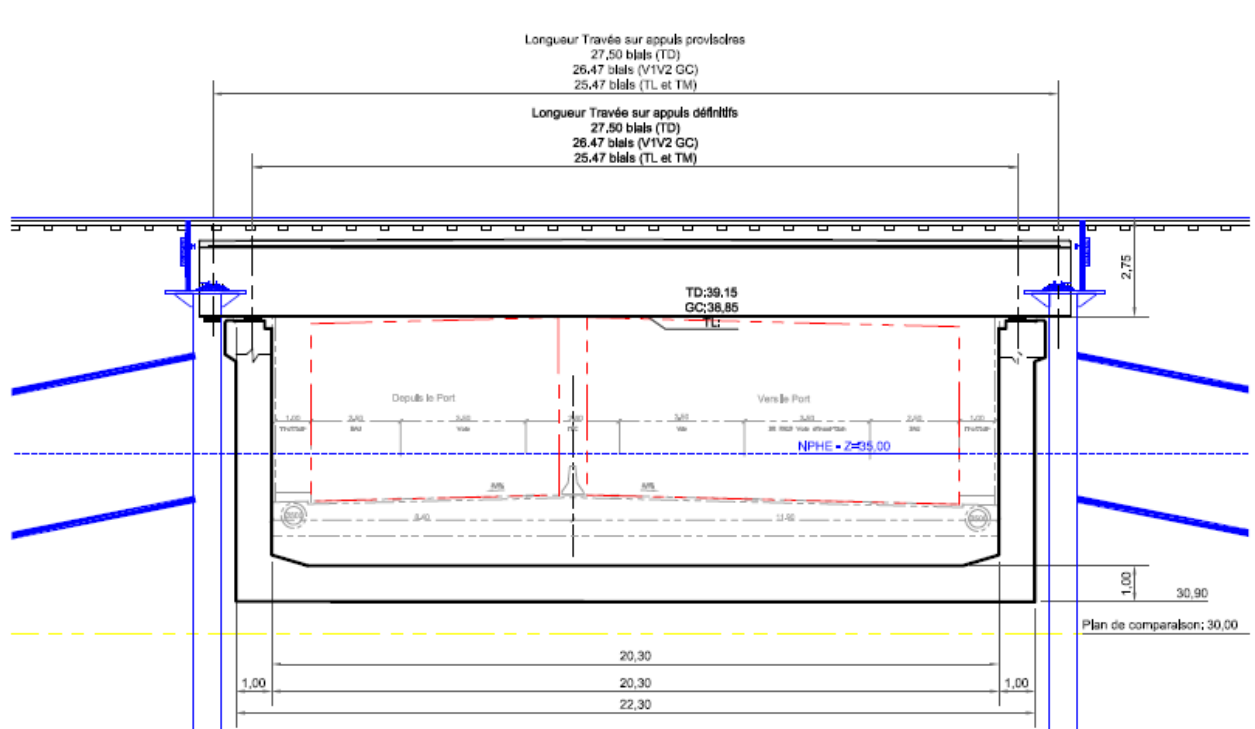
Coupe transversale à la route de l'ouvrage en simple U enterré (source SNCF).
